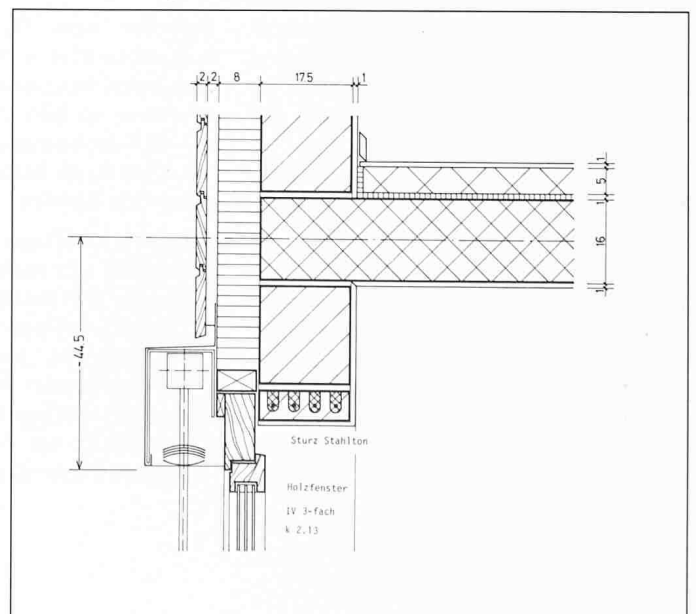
Hinterlüftete Fassade, Detail Sturz mit Lamellenstoren
